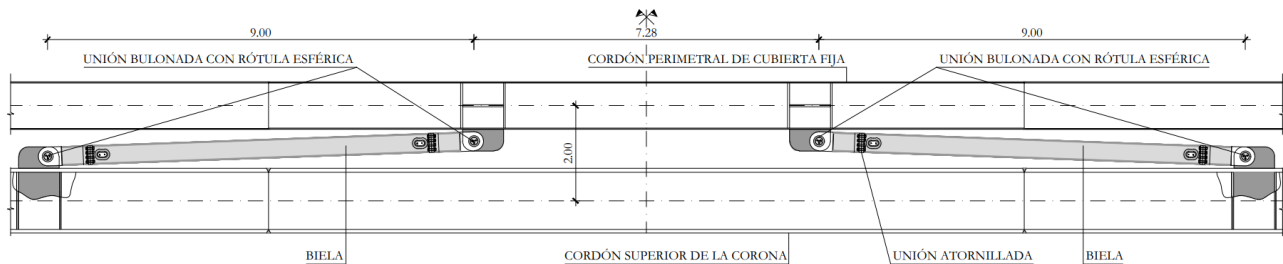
Bielas de bloqueo norte/sur entre Corona y Cubierta.
